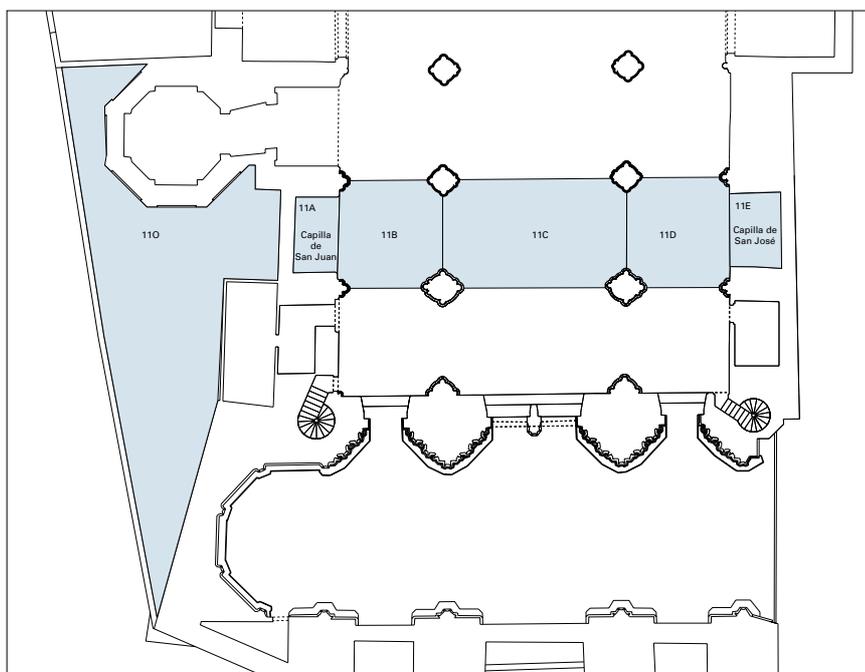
Sector 11. Plano de situación de las zonas de excavación
